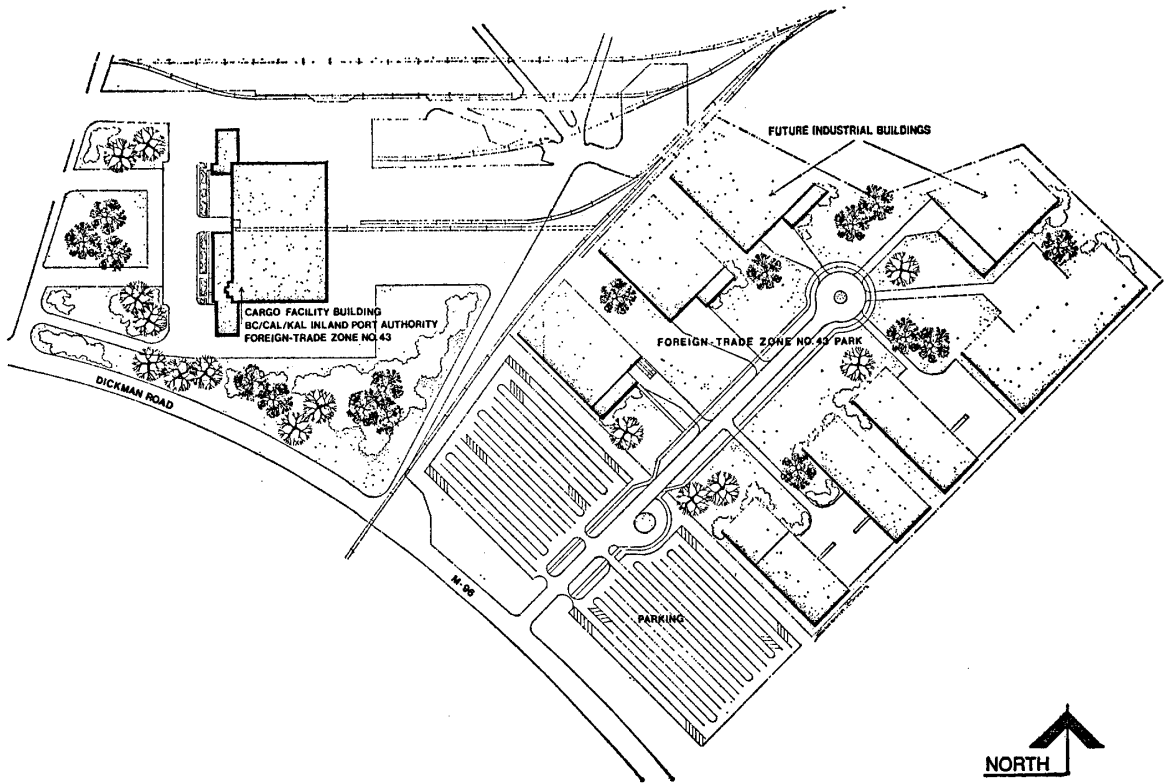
FOREIGN-TRADE ZONE #43 SITE PLAN
